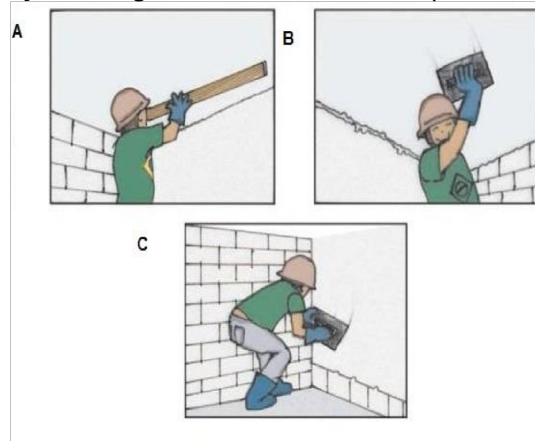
Aplicação da pasta de gesso com a desempenadeira na alvenaria e teto.
